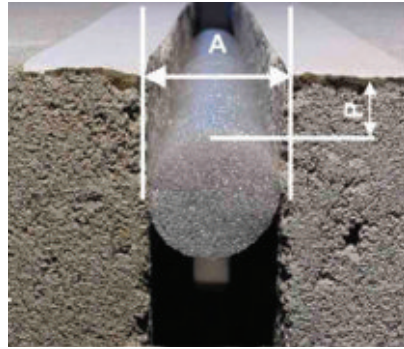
Imagen de la sección de junta de dilatación de la estructura, en la que se indican ancho de la junta («A») y profundidad de la junta delimitada por perfil de poliuretano preformado («P»). FUENTE: equipo de autores.
